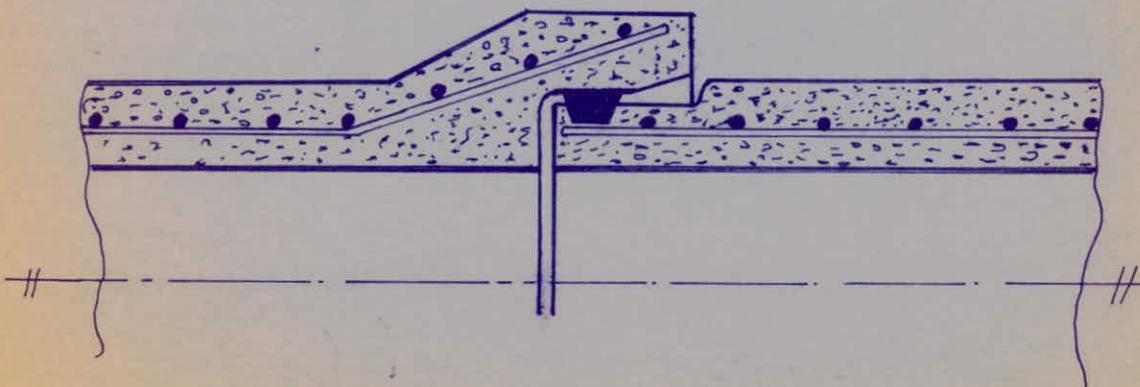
Joint à embout rainuré et anneau d'élastomère plein.
